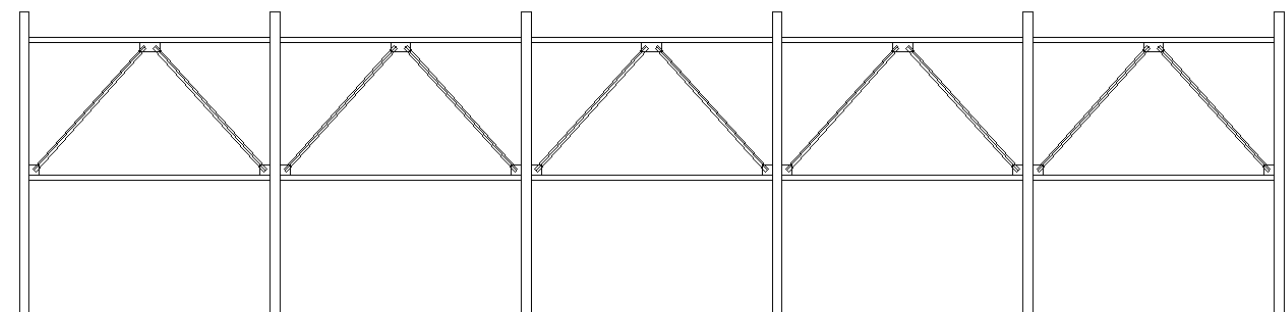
Estructura longitudinal rigidizada con contraventeos rígidos en “V” invertida en un nivel en marcos continuos con trabe intermedia.
